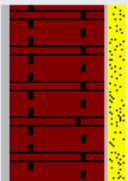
Composición de la fachada principal en el modelo de fachada sencilla.
